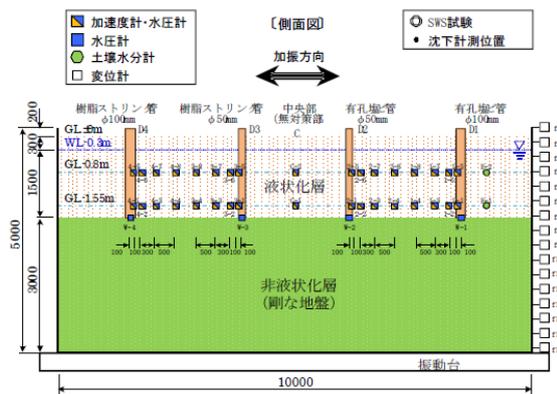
試験体地盤とドレーンパイプ・センサー類の配置
